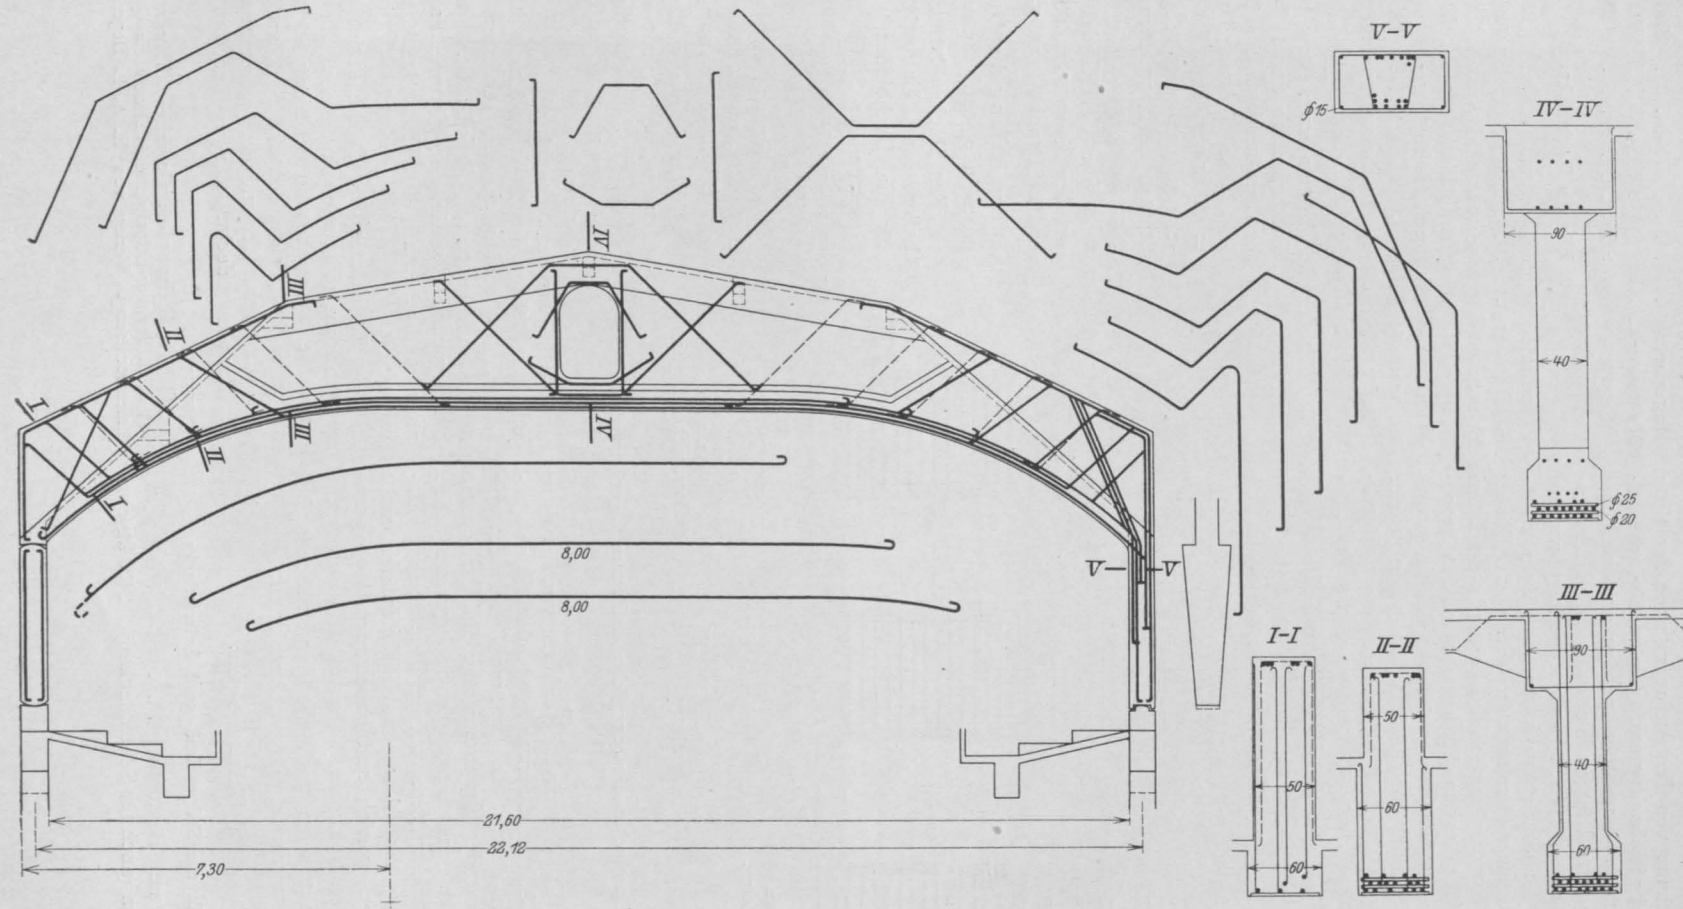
Dachbinder mit Eiseneinlagen und Schnitten I—V.
